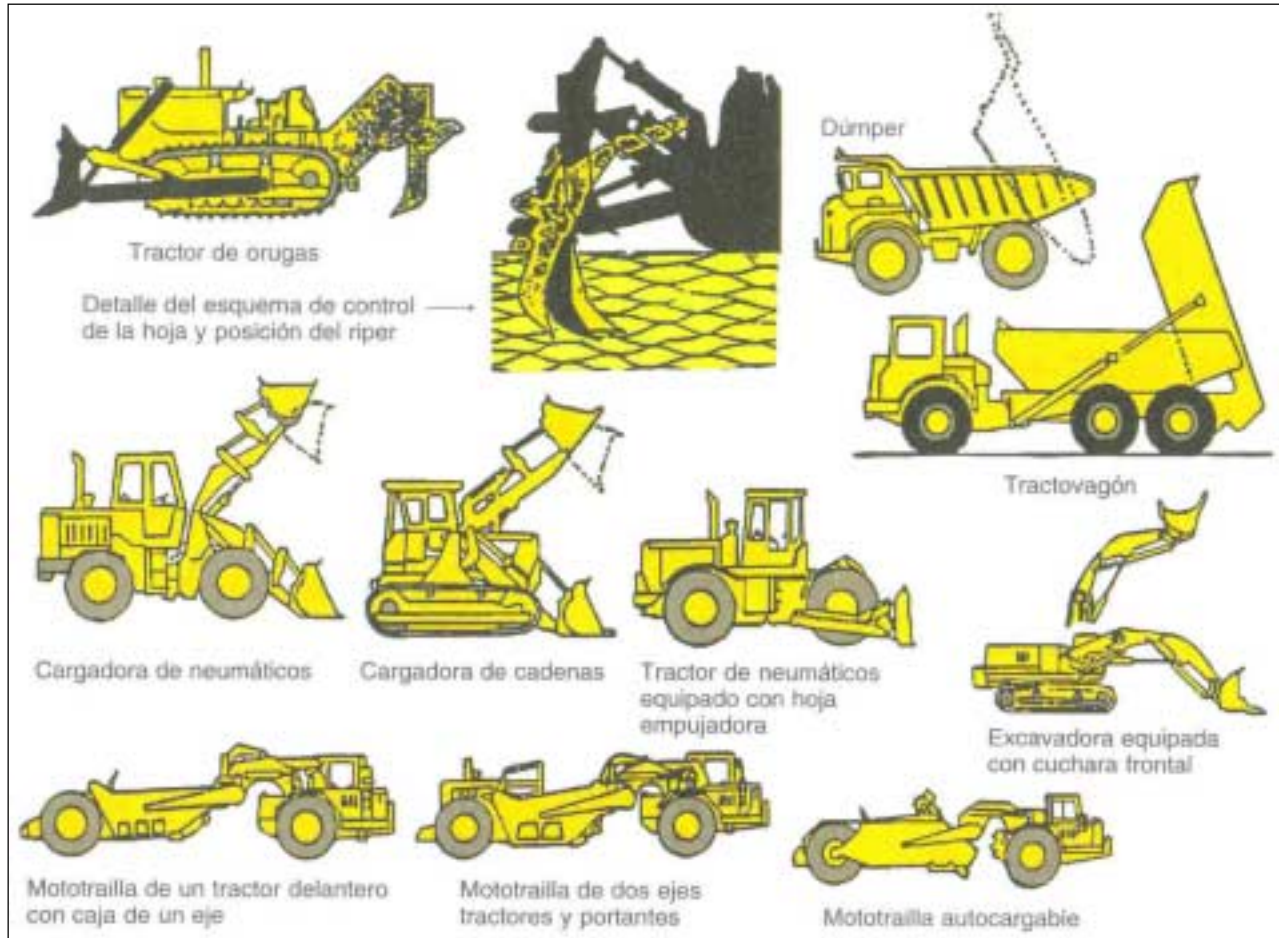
Tipos de maquinaria utilizadas para el movimiento de tierras (Kraemer y otros, 1989).
